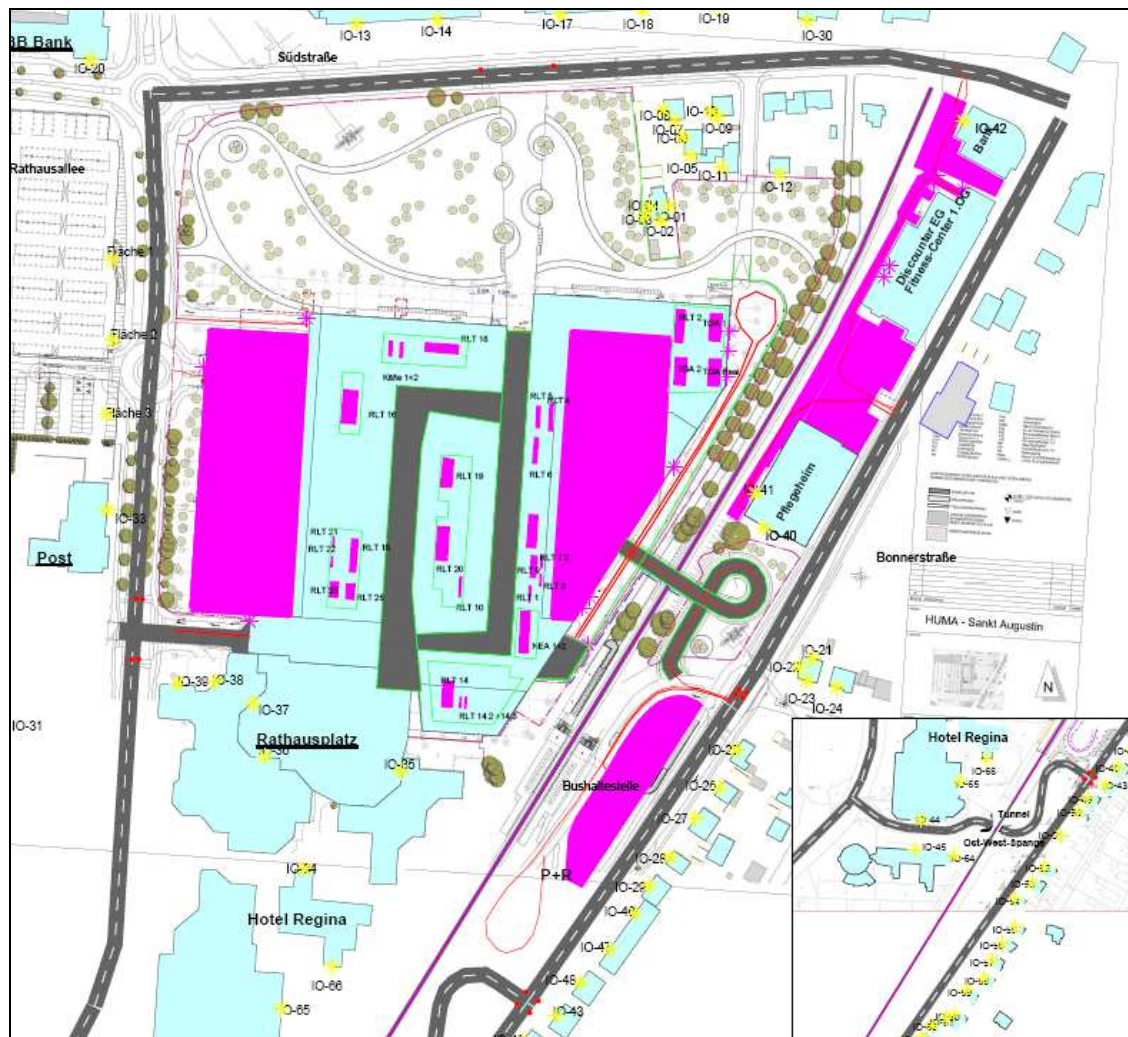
Lageplan Planfall 2 (Anlage 1.2)
